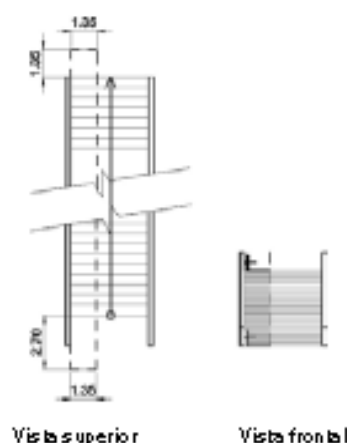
Sinalização de piso junto à plataforma de elevação inclinada
